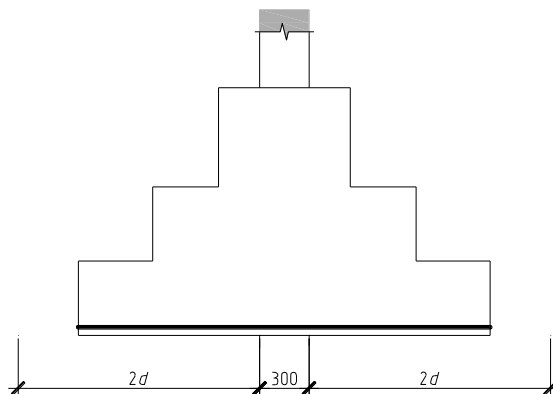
Поперечний розріз фундаменту для розрахунку на продавлювання
